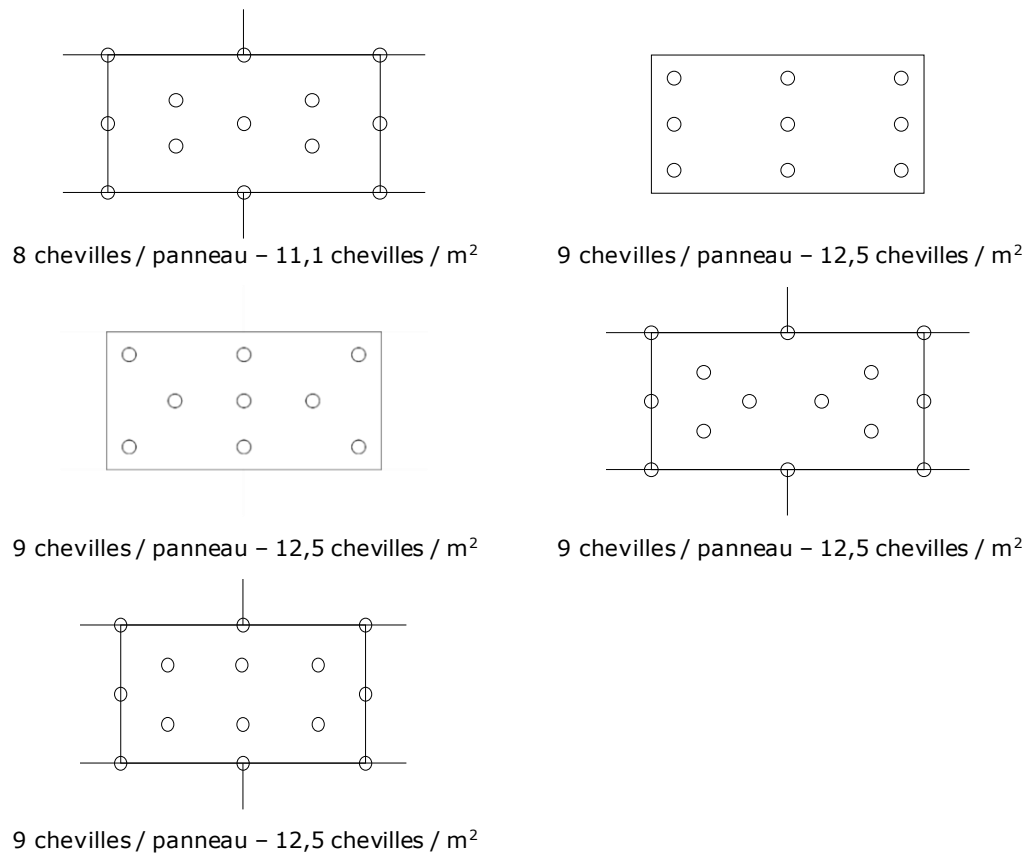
Exemples de plans de chevillage - panneaux de dimensions 1200 × 600 mm
